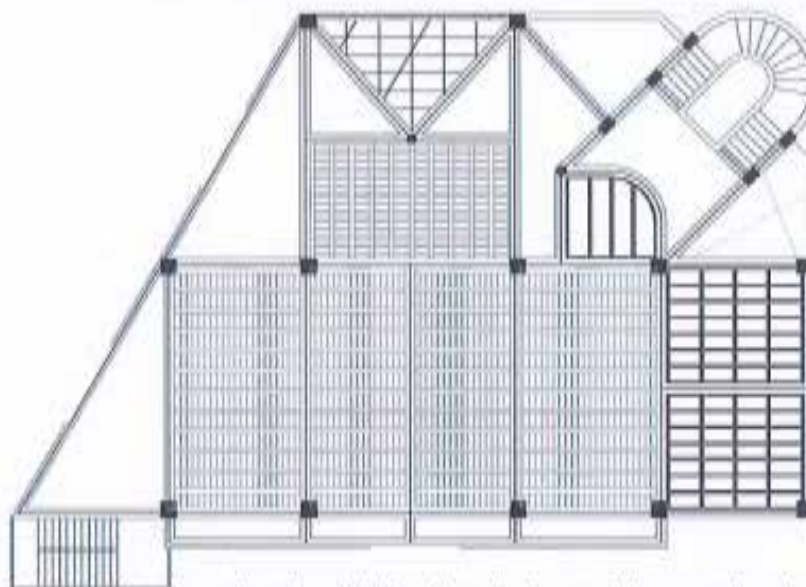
Planta entrepiso distribución de losas del segundo nivel.
